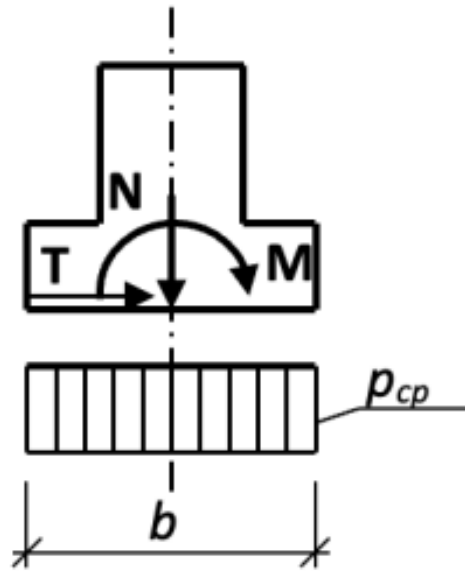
Схема для перевірки напруження під подошвою центрально-напруженого фундаменту
